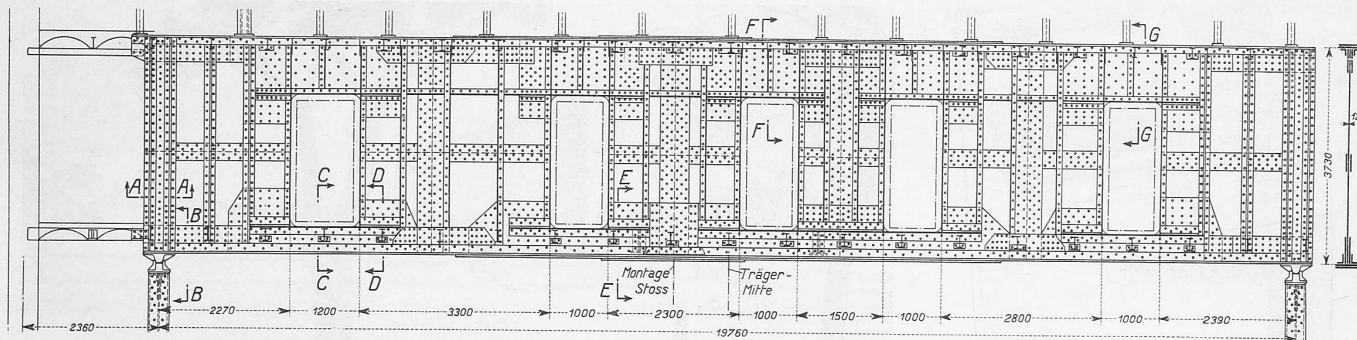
Ansicht des genieteten Blechbalkenträgers von 3730 mm Höhe und 19760 mm Stützweite. — Masstab 1 : 120.
